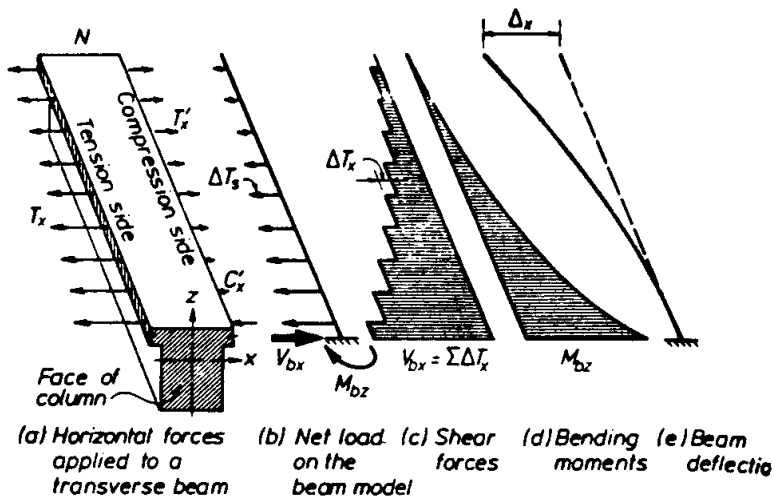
Poutre transversale soumise à d'hypothétiques forces dans le plan de la dalle.
